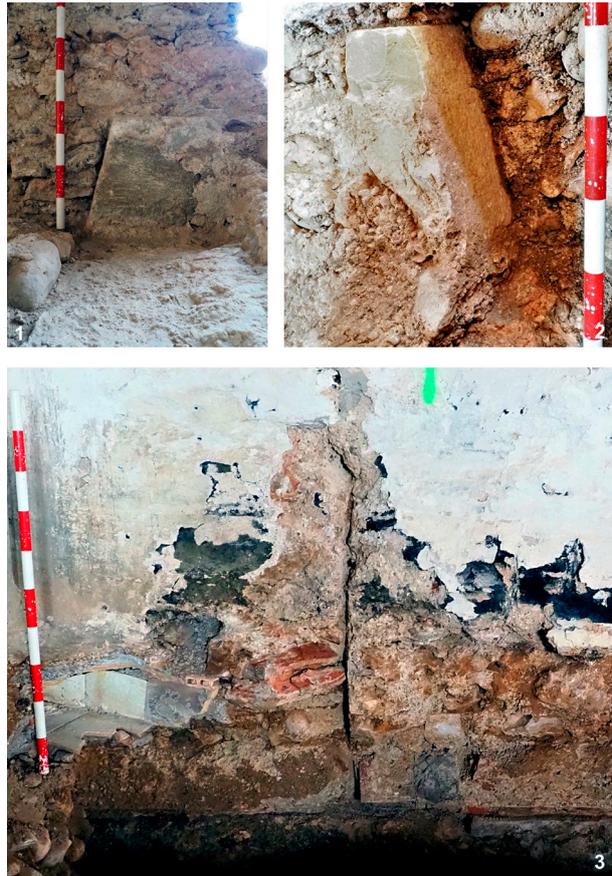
Vistas de detalle de los Sillares conservados en la muralla noroeste, bajo las fachadas del frente del mar (1) y la medianera trasera (2); y junta de una posible puerta tapiada en el muro de la medianera (3).
